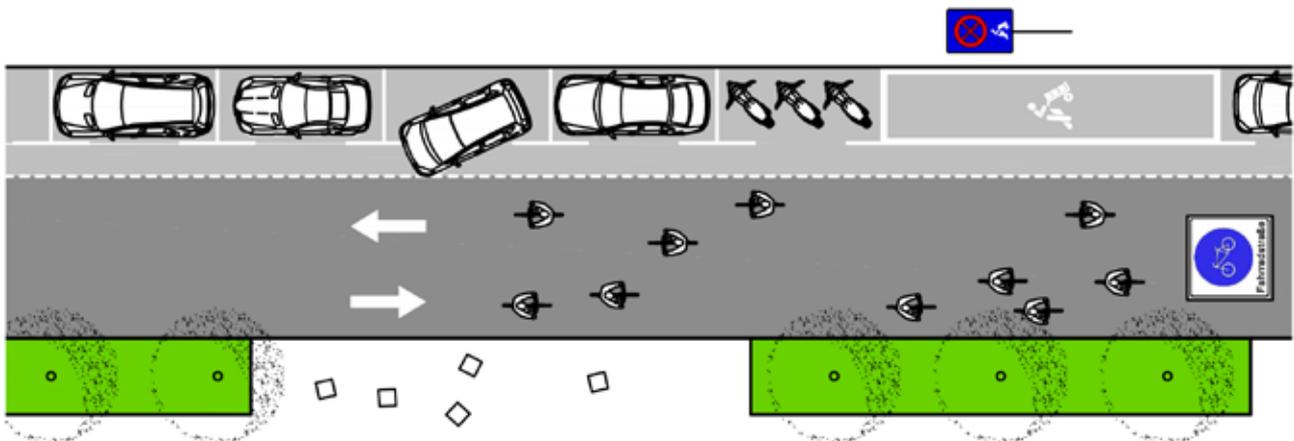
Lageplan, Umgestaltungsvorschlag Nordendstraße
